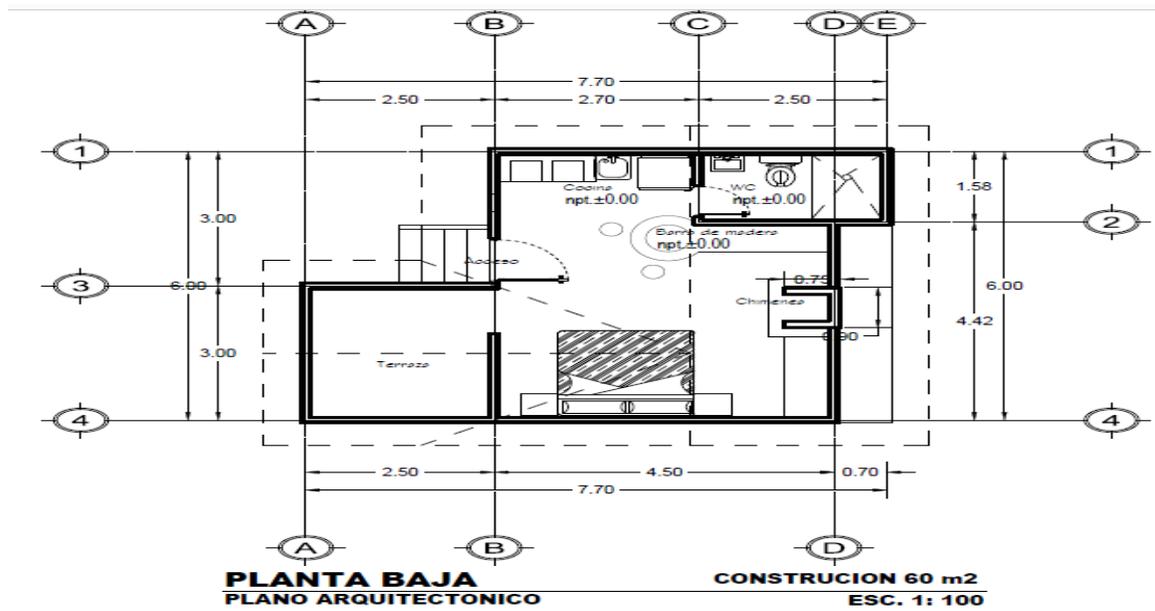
Plano arquitectónico de la cabaña para dos personas.
